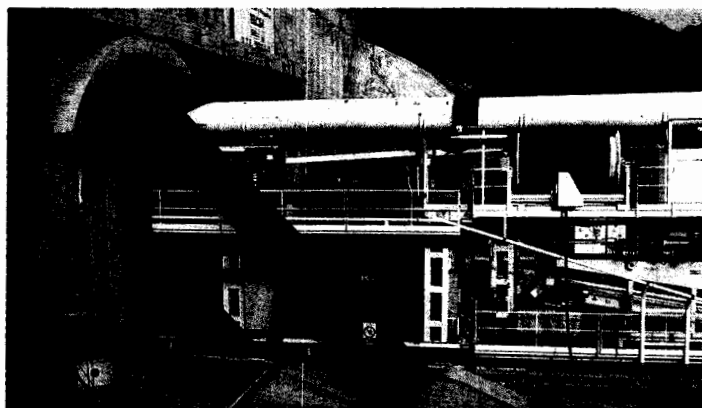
Estructura de reacción para iniciar la excavación del túnel. Photo 2. Reaction structure for starting the excavation of the tunnel.
